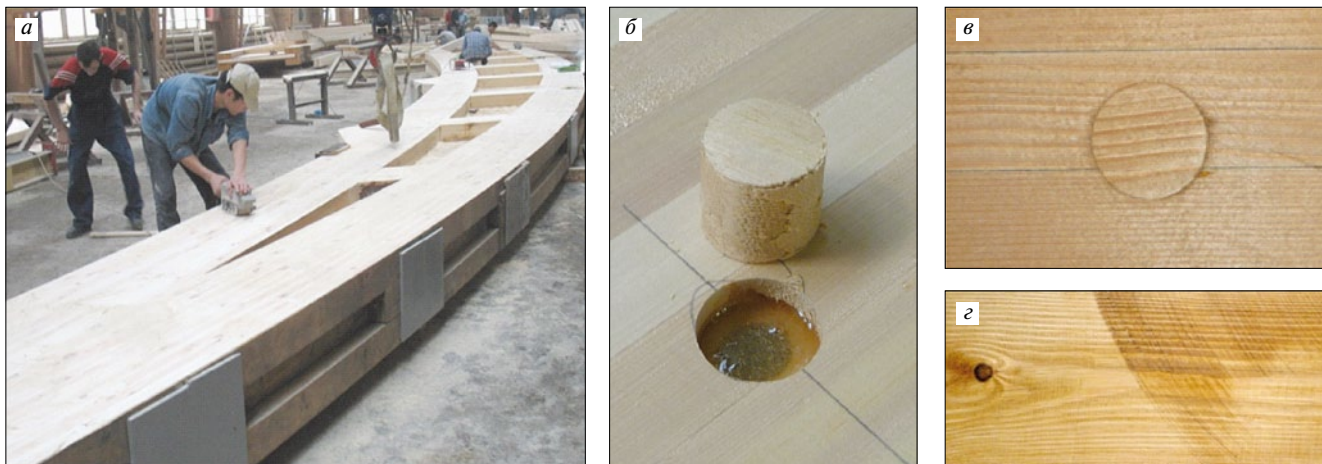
Подготовка поверхности элемента КДК перед нанесением защитных составов: а – шлифование поверхности ленточной шлифовальной машинкой; б – заделка отверстия пробкой в месте установки металлического стержня; в – поверхность элемента с пробкой после шлифования; г – неравномерное окрашивание древесины в результате шлифования ее поперек волокон
